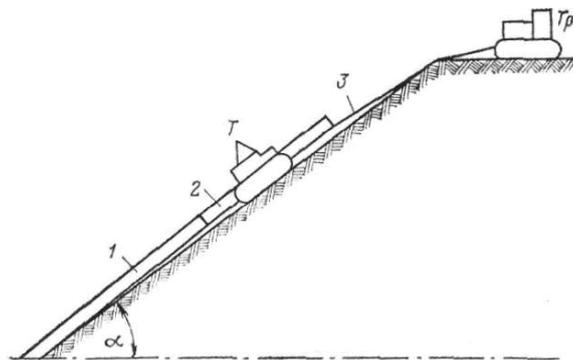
Схема наращивания трубопровода снизу вверх с доставкой труб на уклон трубоукладчиком:
